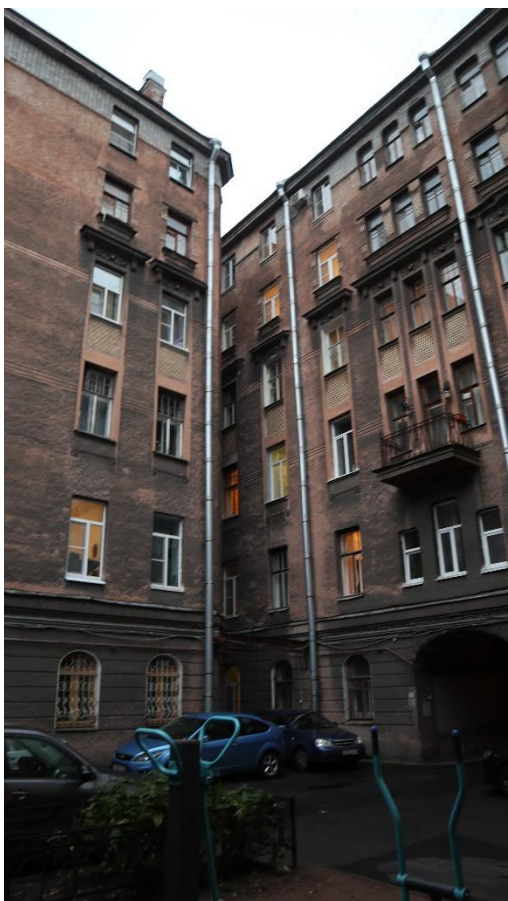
, 8. Фасады здания, ориентированные на курдонёр.
